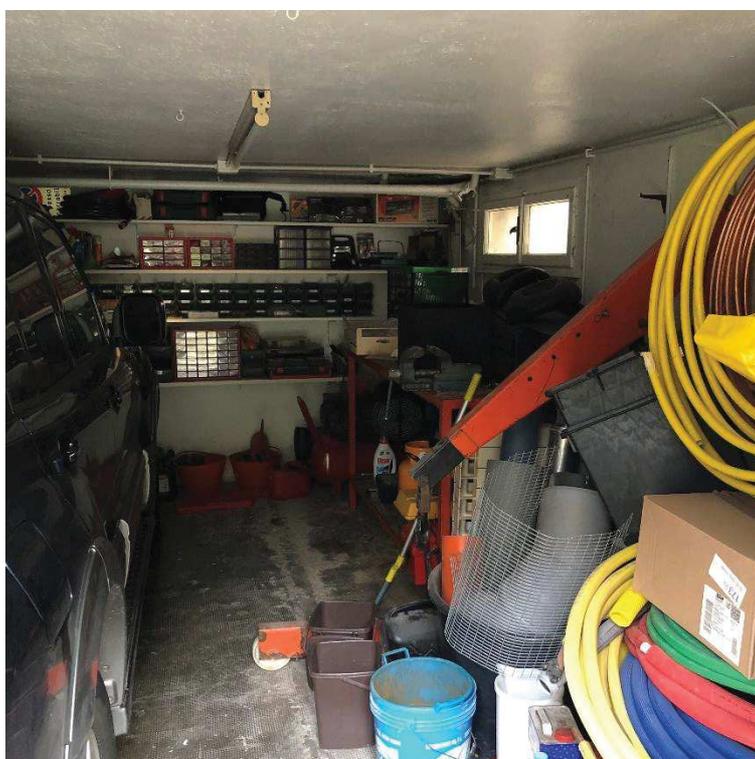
Garage (sul pavimento e sul soffitto le tracce della parete che delimitava la cantina pignorata)
